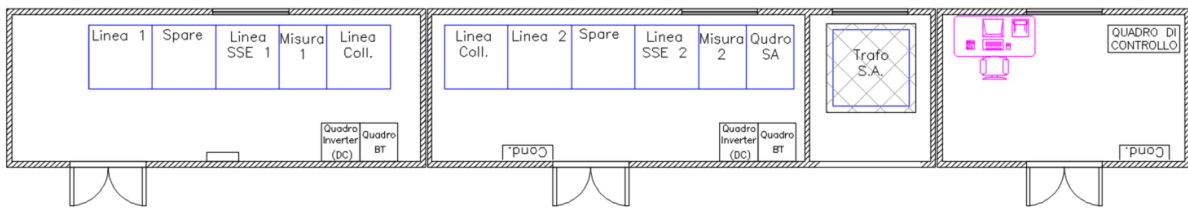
Planimetria quadro di raccolta e misura: zona 1
